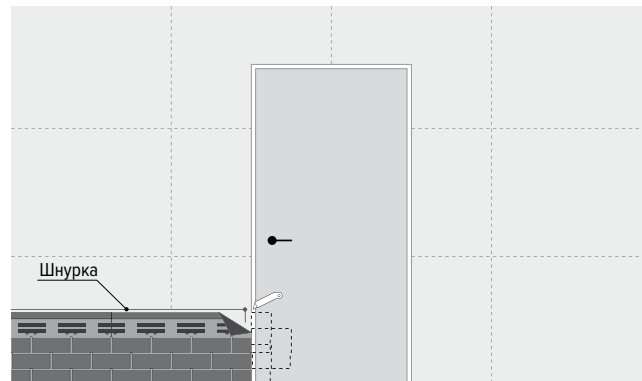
Монтаж фасадной плитки вокруг дверных проемов
